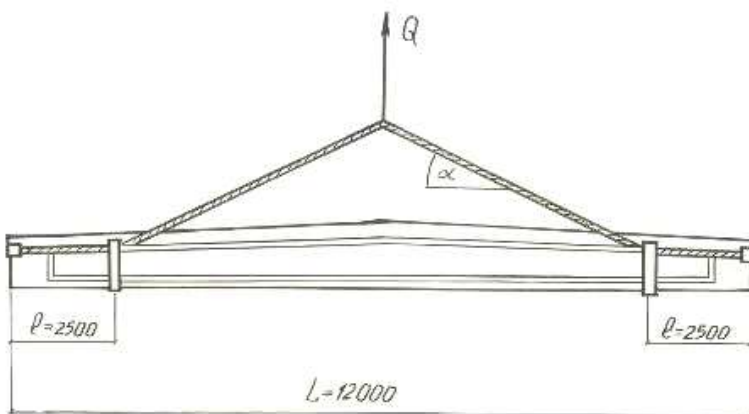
Схема напряженного стропования двускатной балки пролетом 12 м
